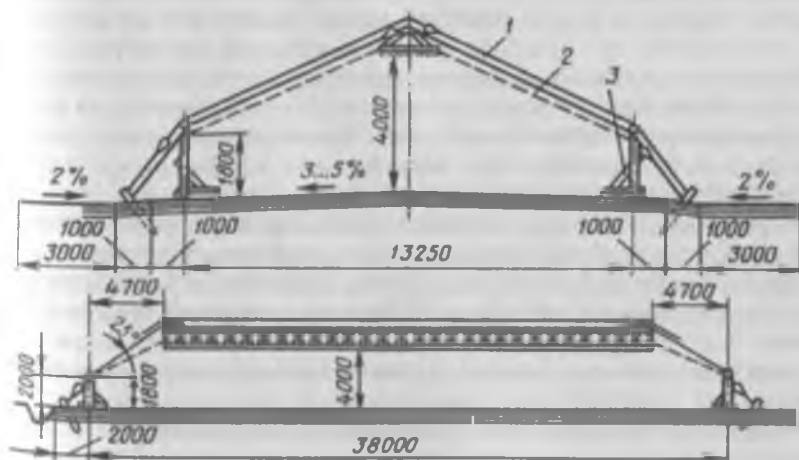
Типовой бунт для зерна со стенами из хлебных щитов:
